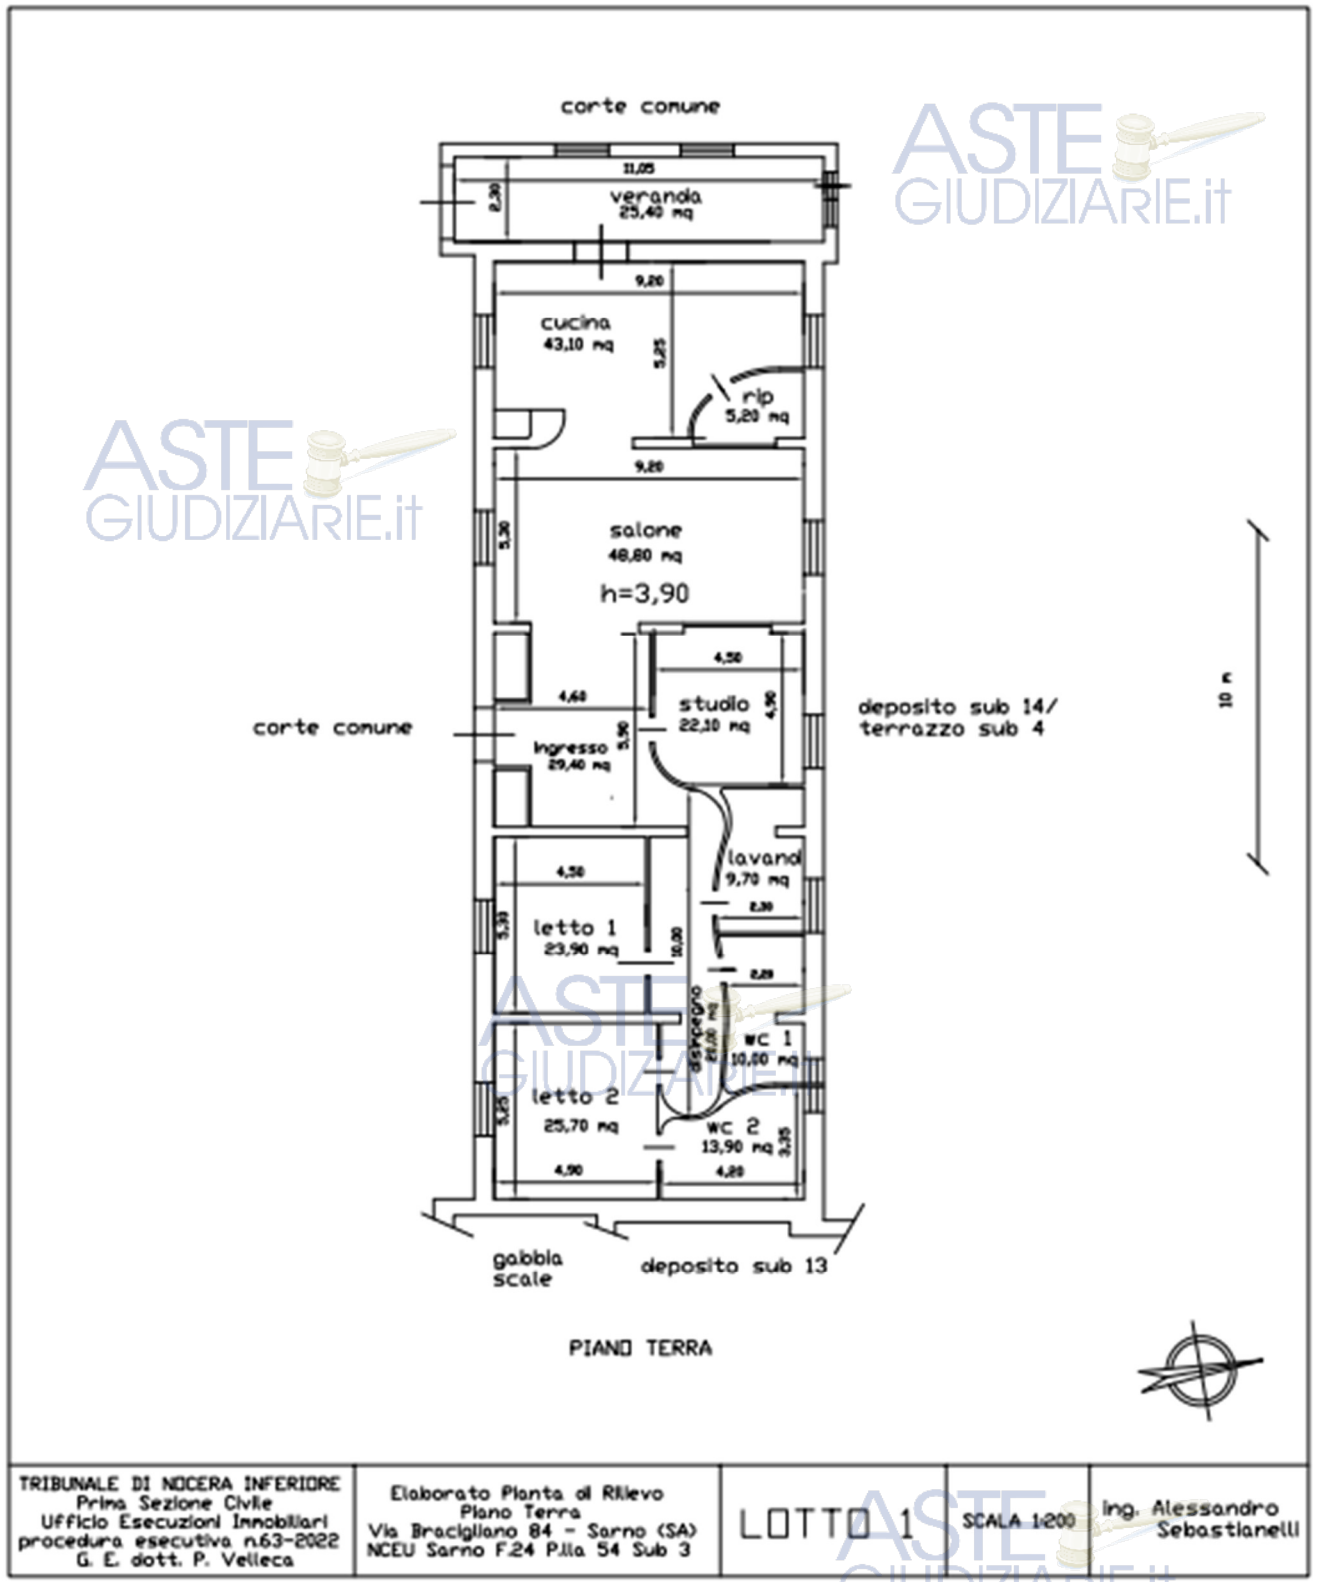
Planimetria stato di rilievo appartamento pignorato PT lotto 1 (F.24 p.IIa 54 sub 3)
